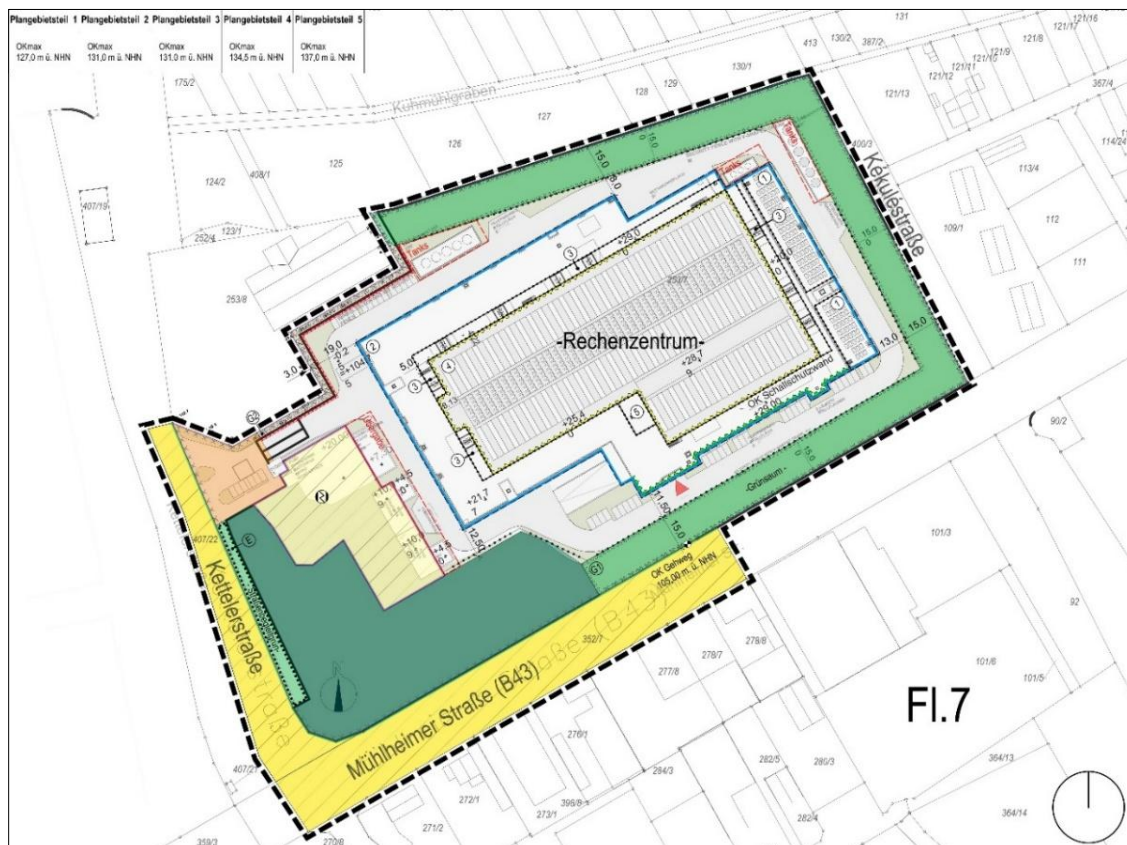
Vorhaben- und Erschließungsplan mit Planzeichnung überlagert, Stand 06.2024
